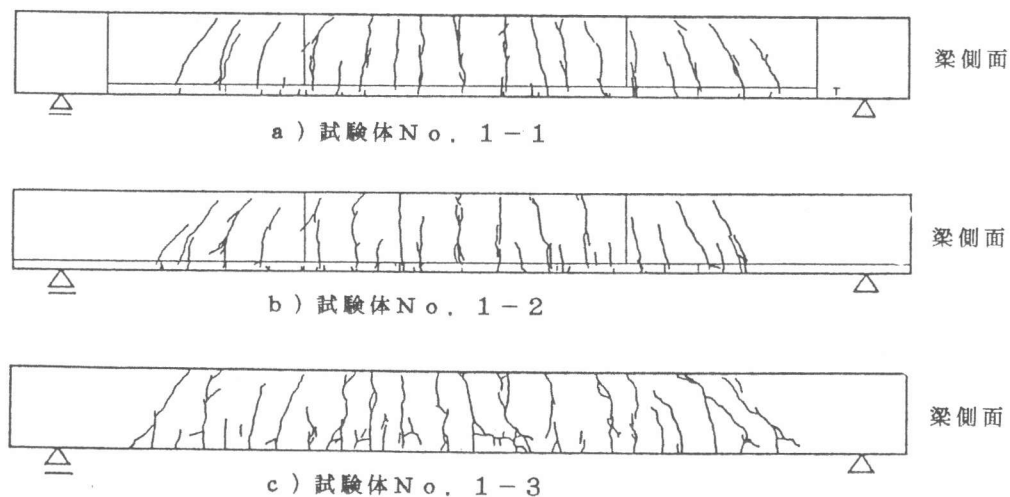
ひび割れ発生状況 (第Ⅳフェーズ、R=1/100 rad.)
